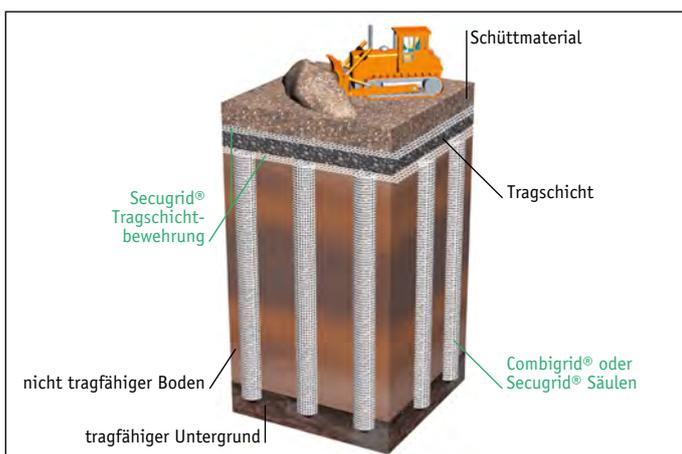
Tragschichtbewehrung auf weichen Untergründen
